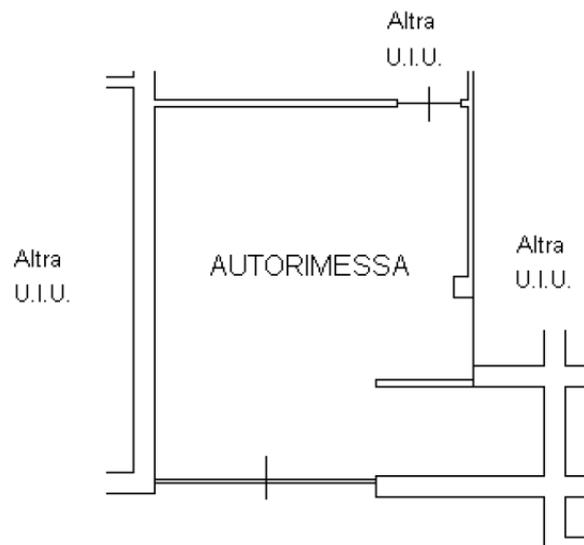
Estratto della planimetria catastale – sub. 7, p.int.
